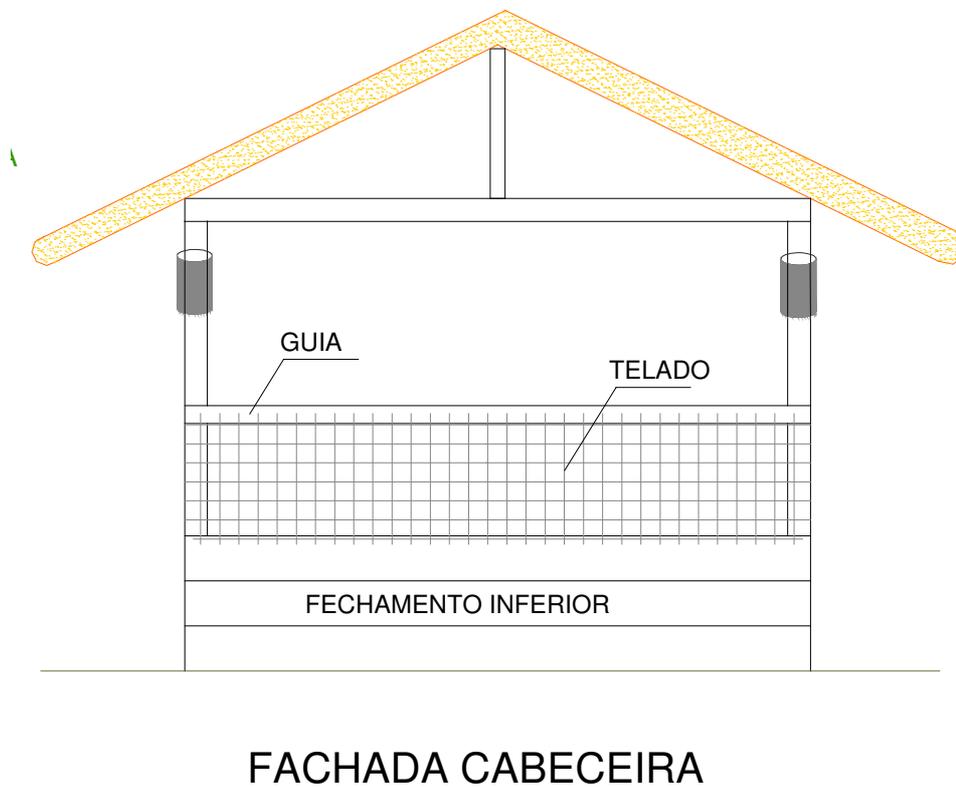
Vista da fachada da edificação para a produção de suínos em cama sobreposta - Fachada Cabeceira
